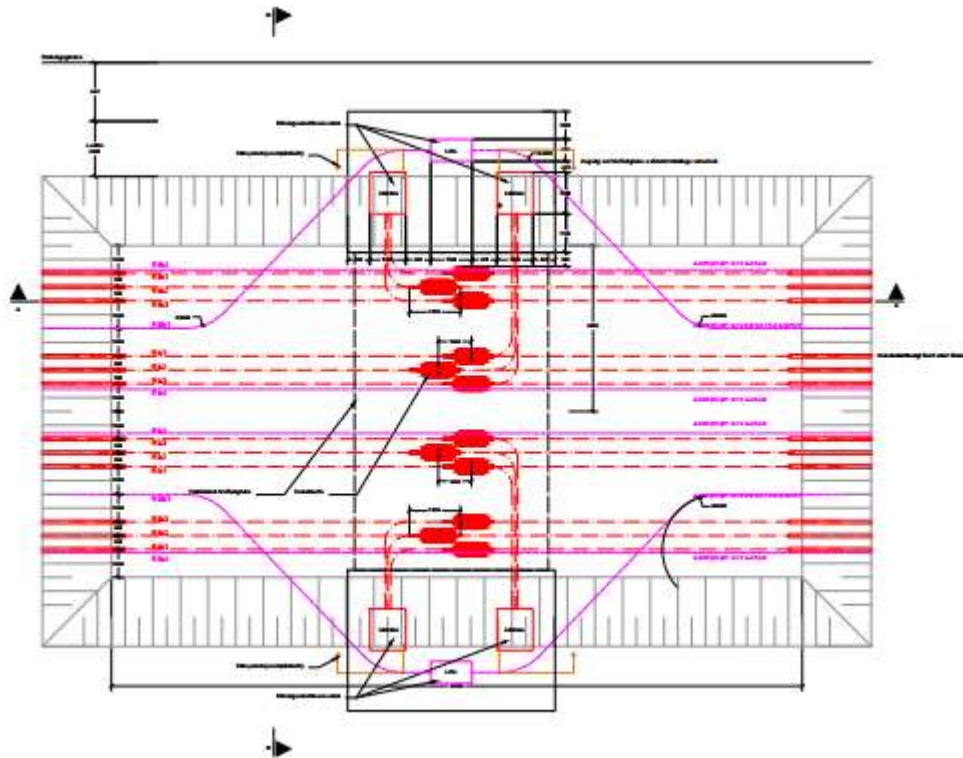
Draufsicht Muffengrube 380 KV Kabel (El Tatawy, Hiesl, Schusseck, & Dittrich, 2022)
